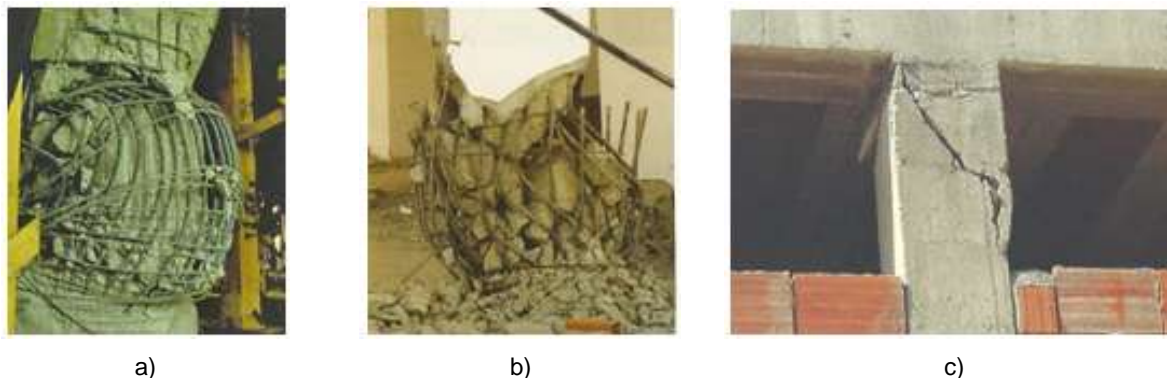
Danos estruturais devido a má pormenorização [1]: a) e b) cintagem deficiente de pilares; c) formação de pilares curtos e deficiente cintagem.
